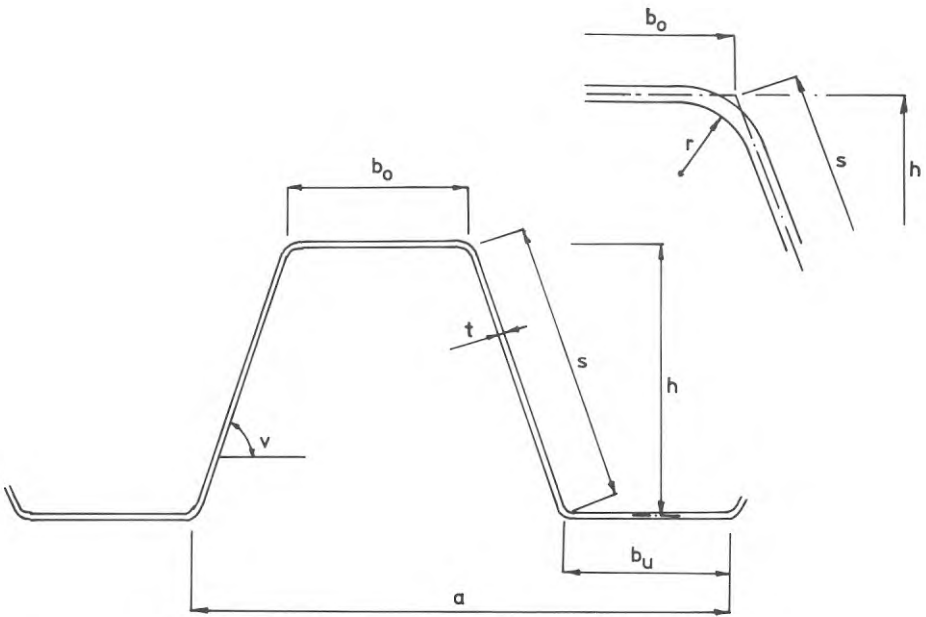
Trapetsprofilerad plåt. Beteckningar för tvärsnitt
